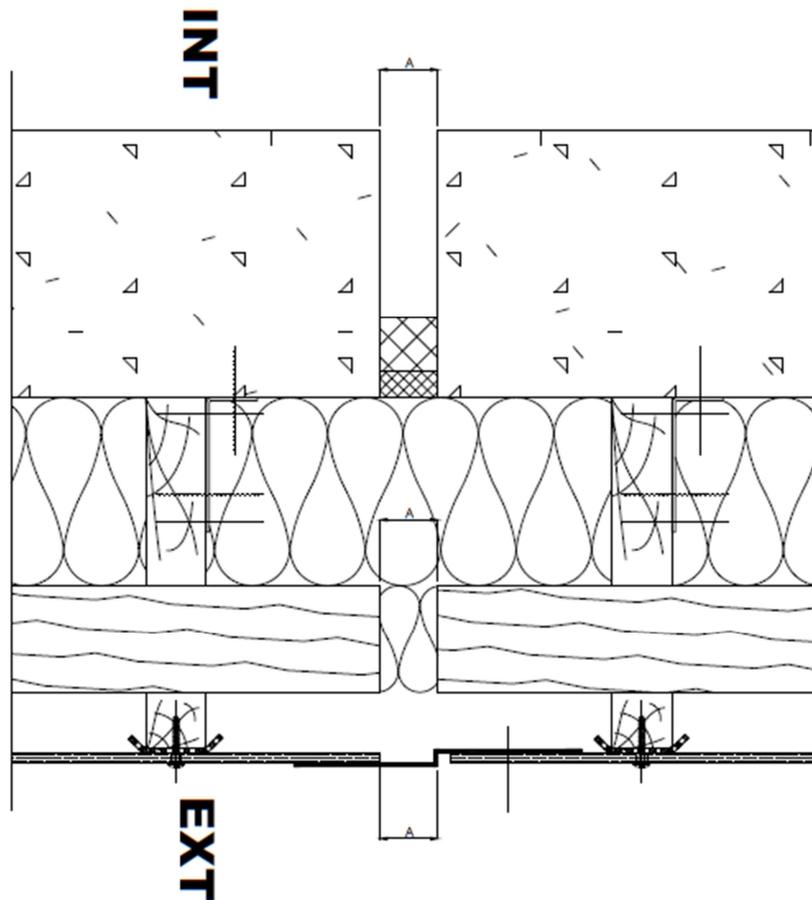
Traitement sur BA en multi réseau - Joint de dilatation – coupe horizontale
